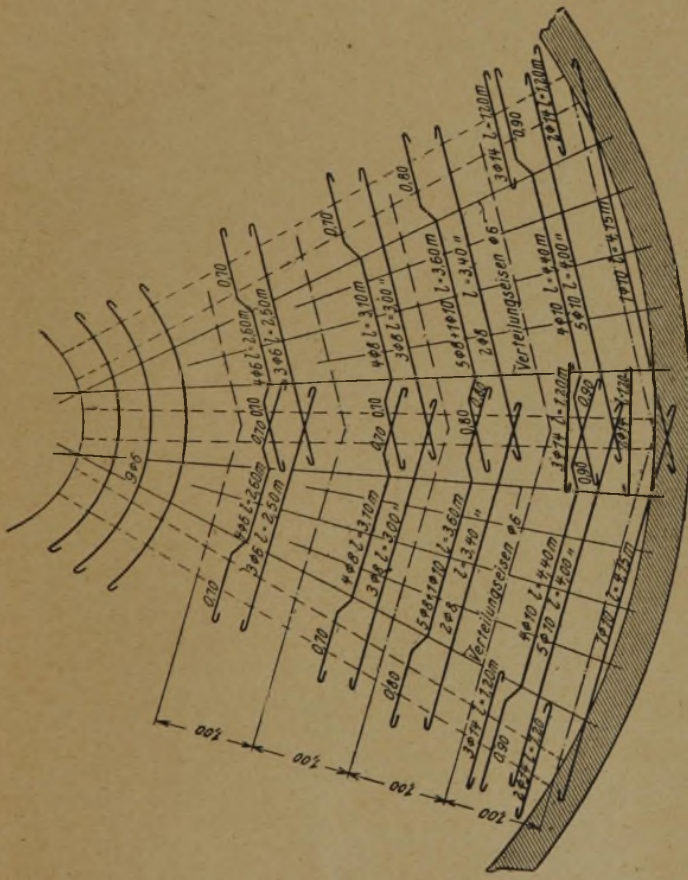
und 9. Bewehrung der Behälterwand im Grundriß und Aufriß.
